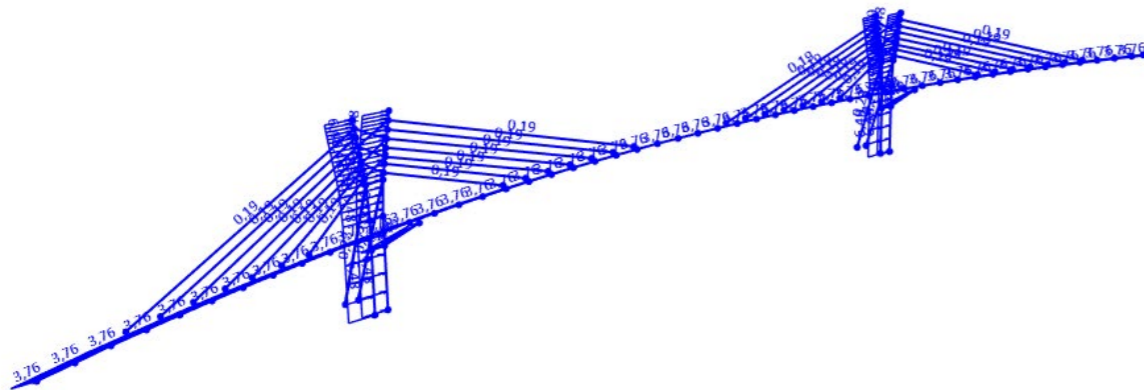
Viento longitudinal "X" positivo aplicado sobre el modelo de la estructura. Fuente: Elaboración Propia (SAP2000)
